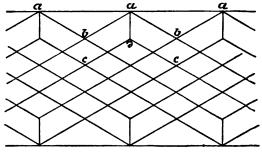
Netzgewölbe im Münster zu Straßburg.
